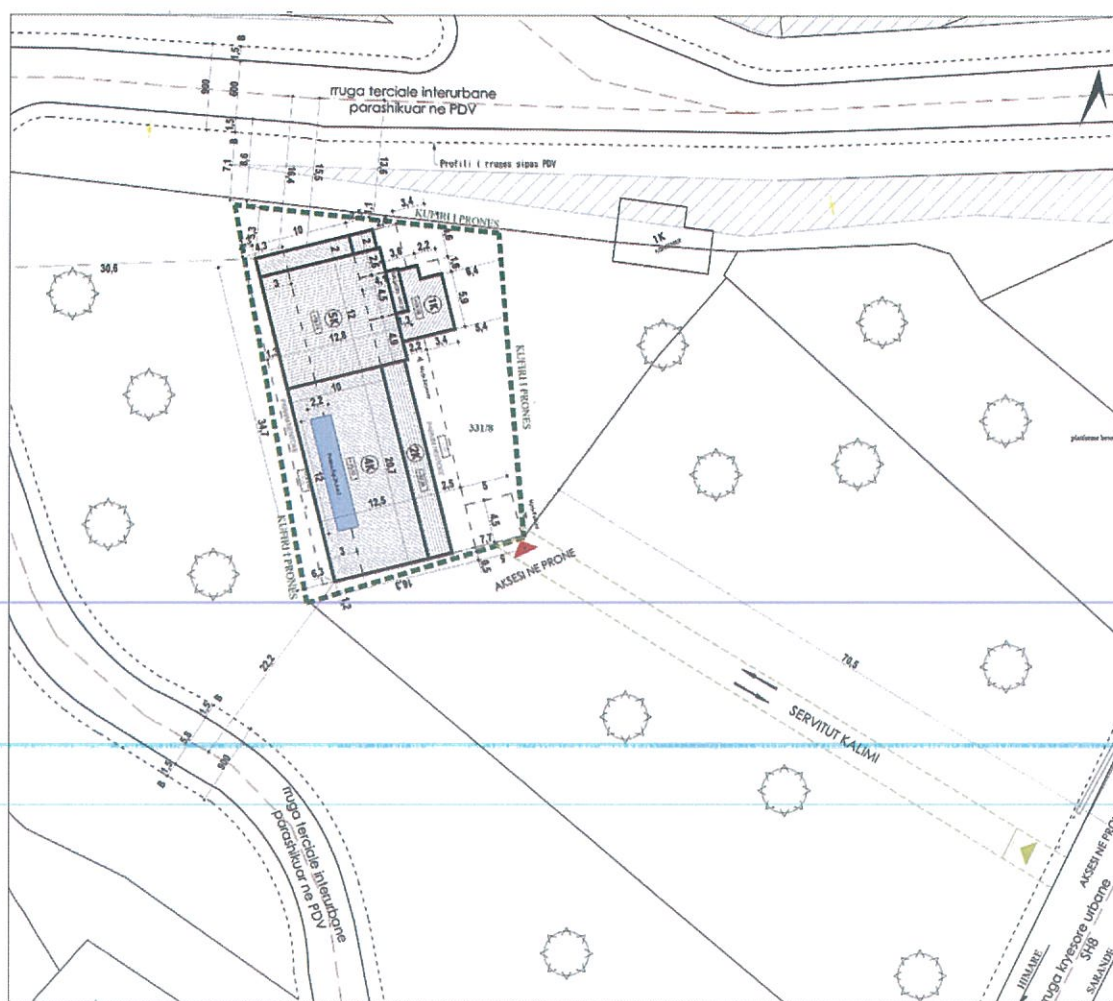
Plani Vendosijs dhe Aksesi në objekt
